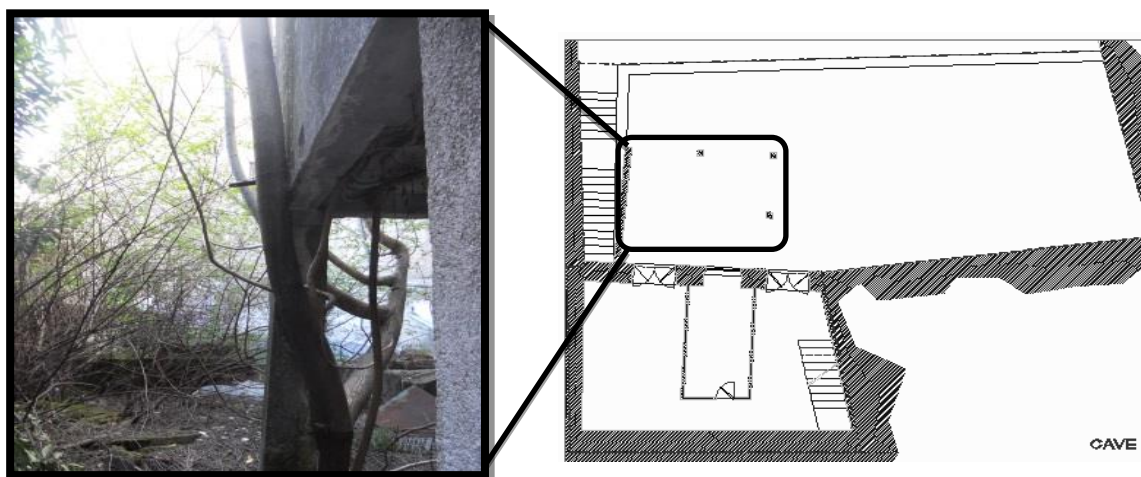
Anomalia 5 - Fotografia e localização em planta
